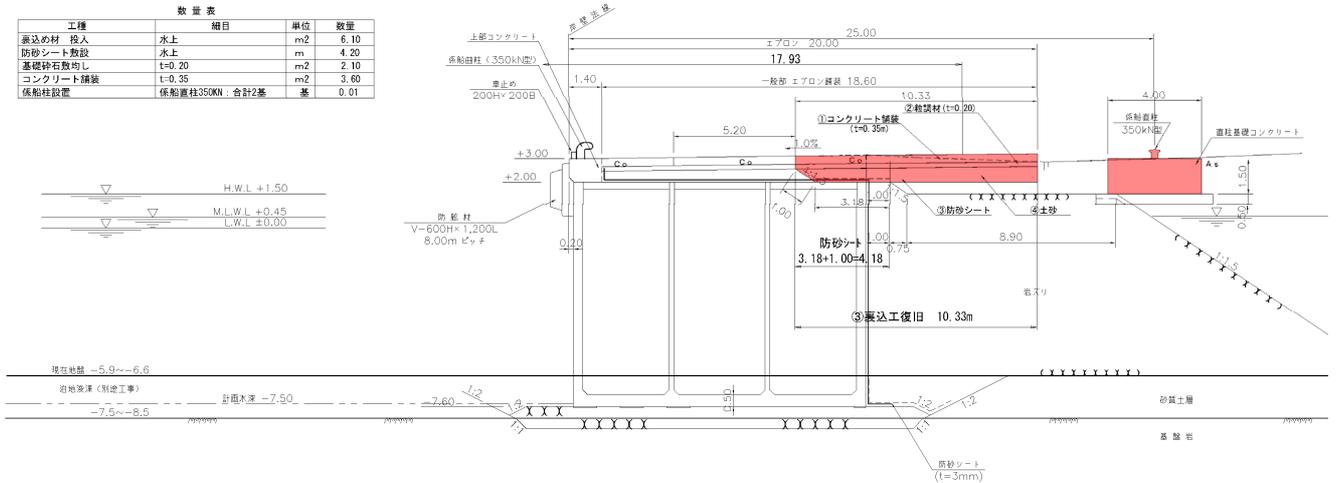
No.20 常陸那珂港区_中央ふ頭地区岸壁 (-7.5m) の断面図 (復旧後)
